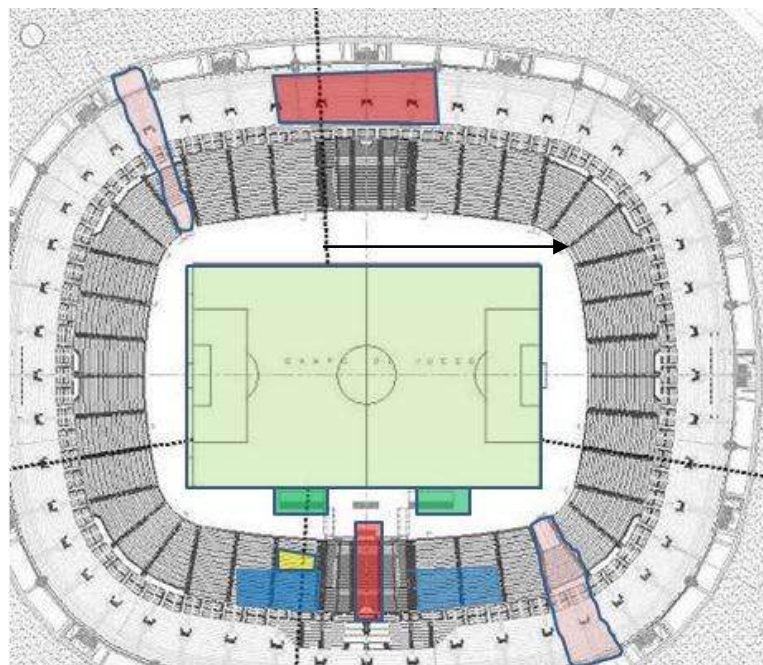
, PLANTA ARQUITECTÓNICA GRAL. J.A.R.O.
